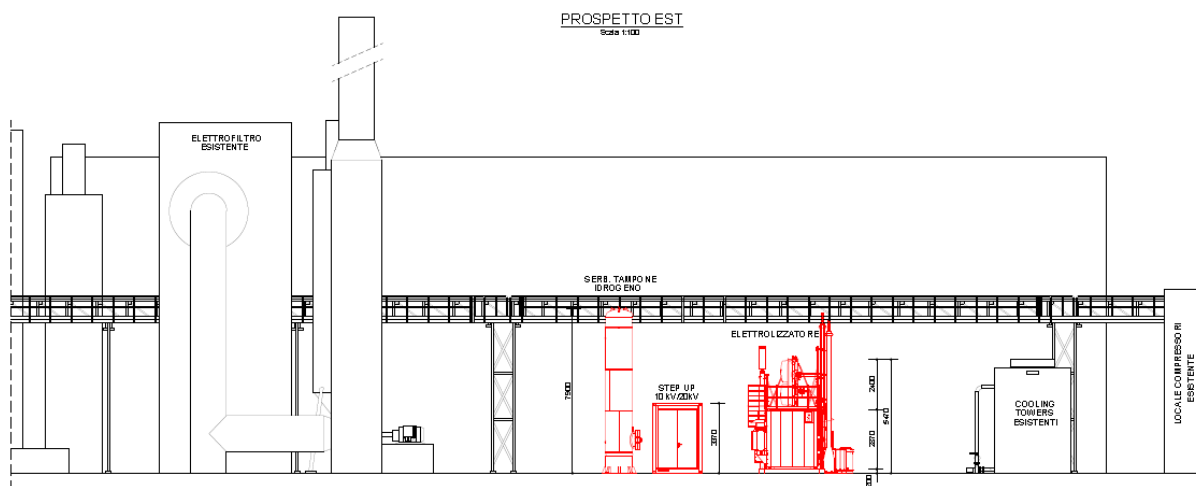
Layout di progetto – Prospetto Est Zona 1 di intervento
